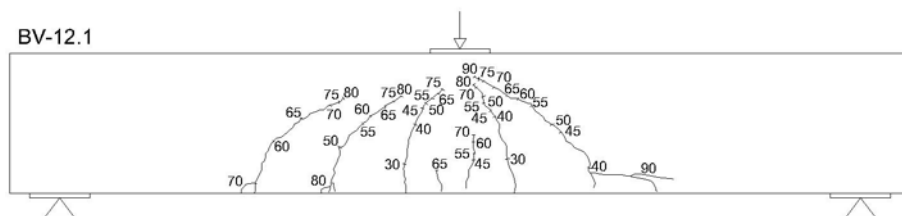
Rissbild BV-12.1 mit Laststufen
